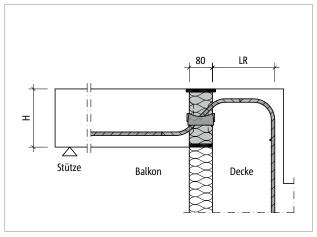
Schöck Isokorb® T Typ QL-WU: Balkon mit Höhenversatz nach oben und Außendämmung
